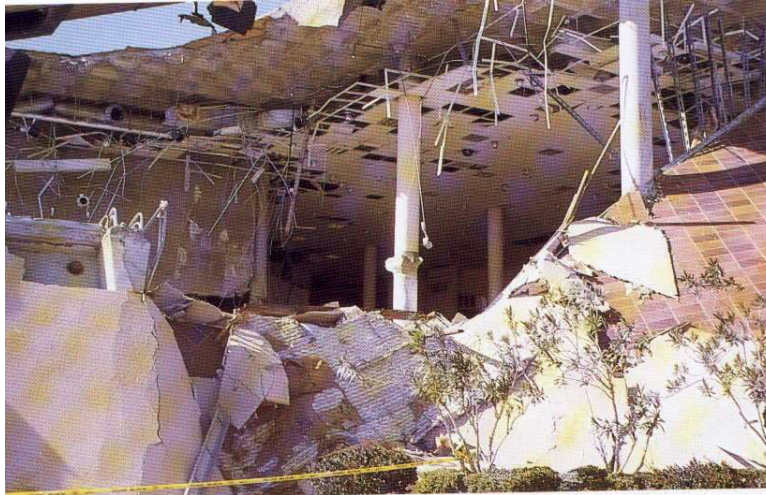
Aspecto dos pilares isolados evidenciando o colapso da laje [20].
